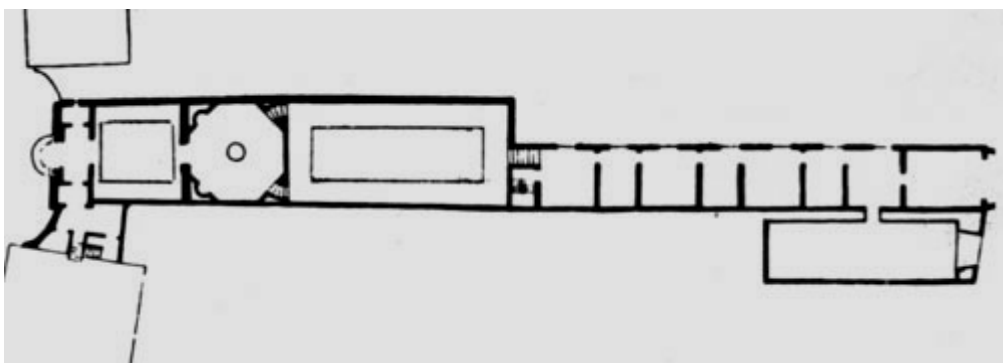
Planta del Museo de Faaborg (Dinamarca).
